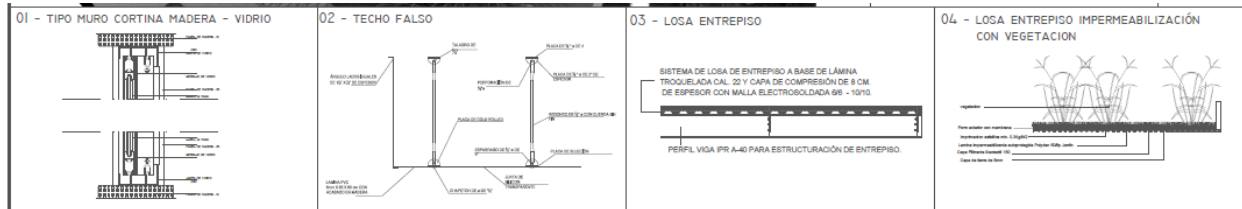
Detalles constructivos. Nota: Muestra cómo van algunas zonas internas. Elaboración propia: Photoshop
